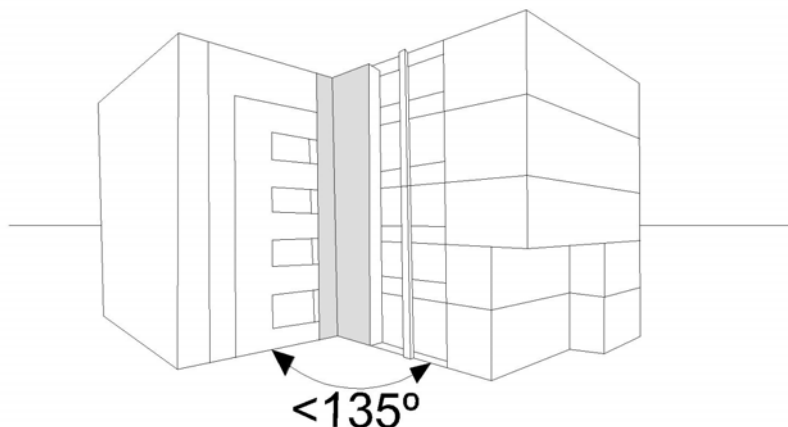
Exemplificação da faixa vertical de protecção de um edifício com fachadas em diedro
